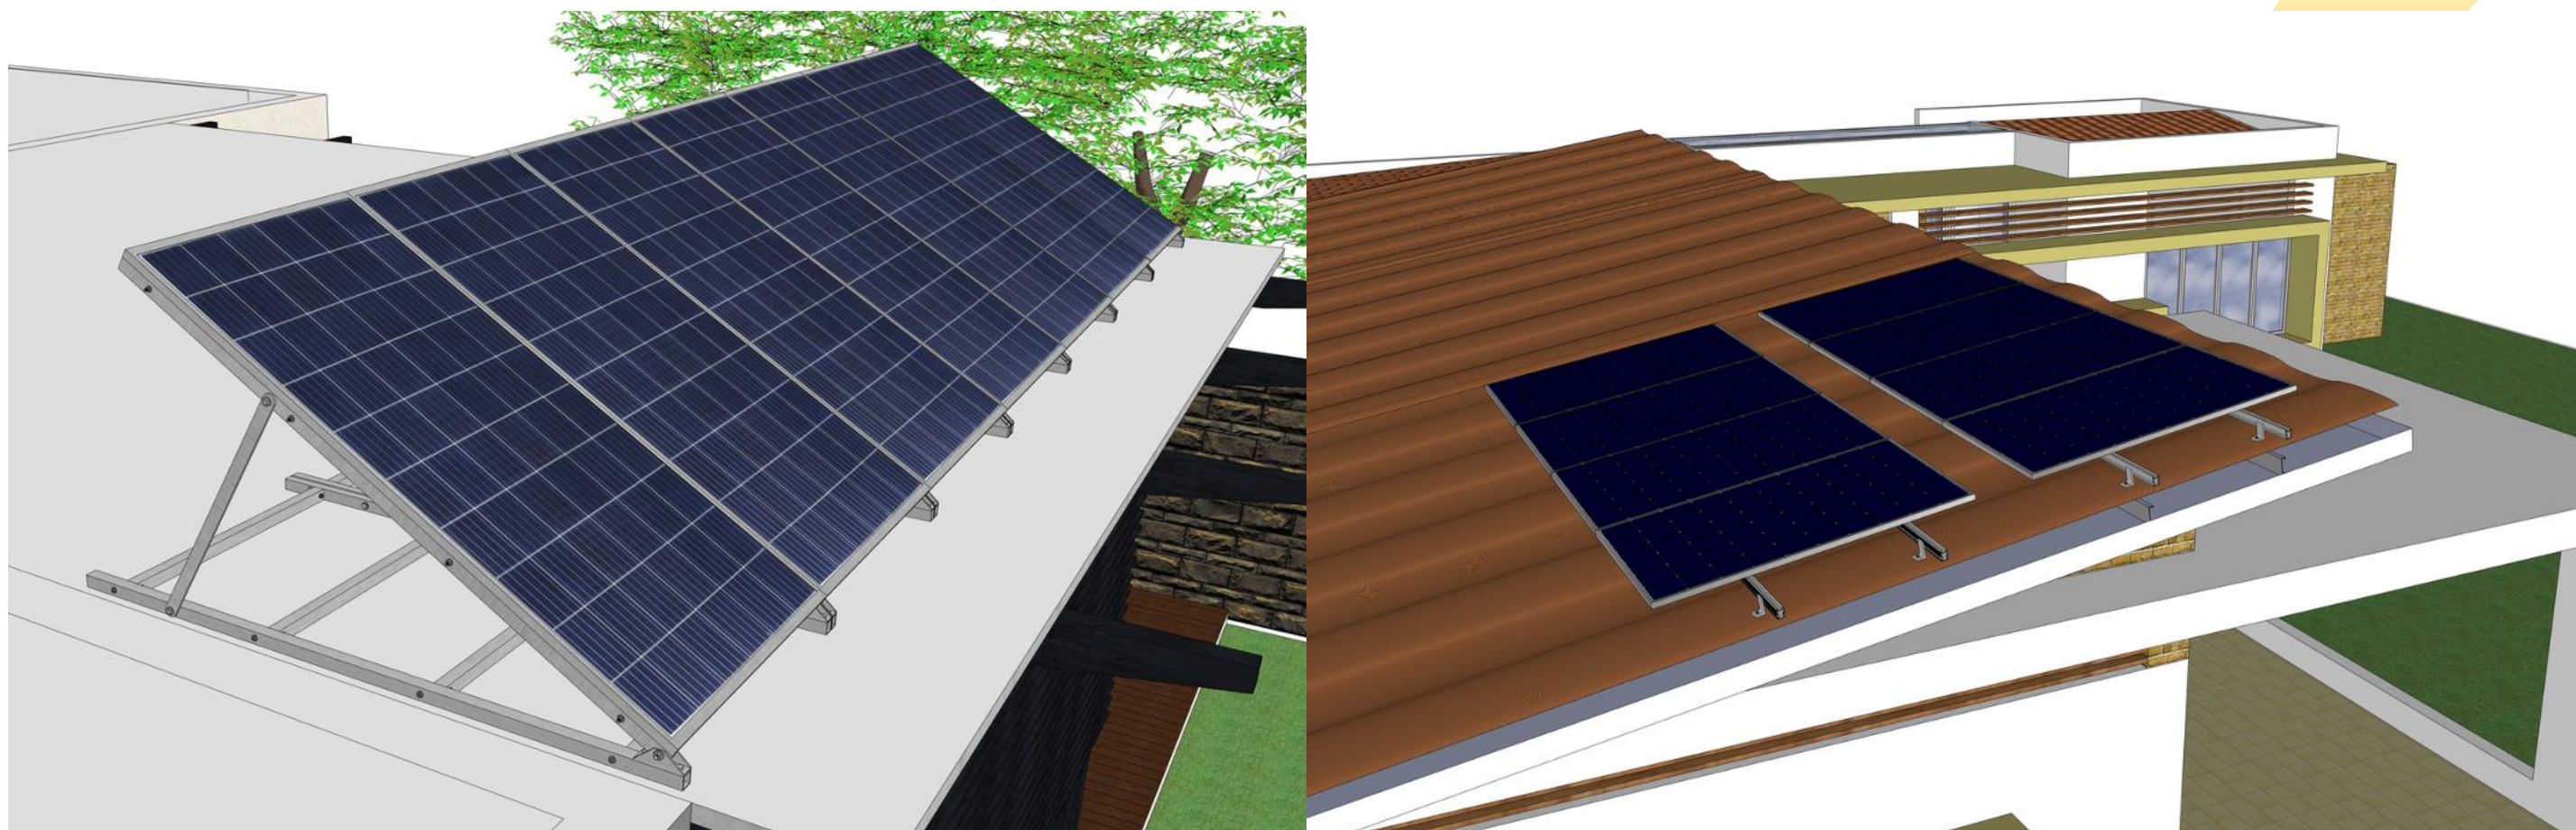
Estructuras de soporte para módulos fotovoltaicos en cubiertas planas e inclinadas
